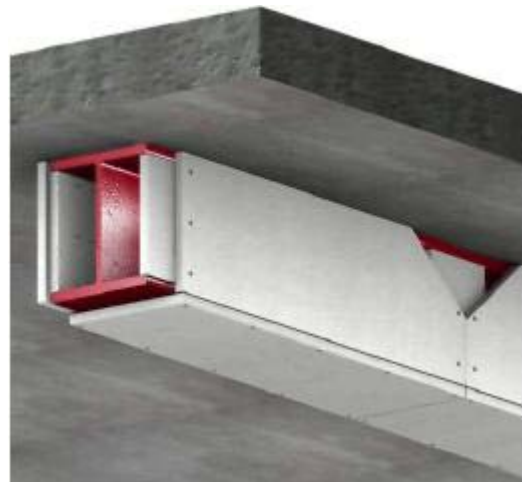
, Revestimiento de viga de acero estructural con paneles a prueba de fuego
